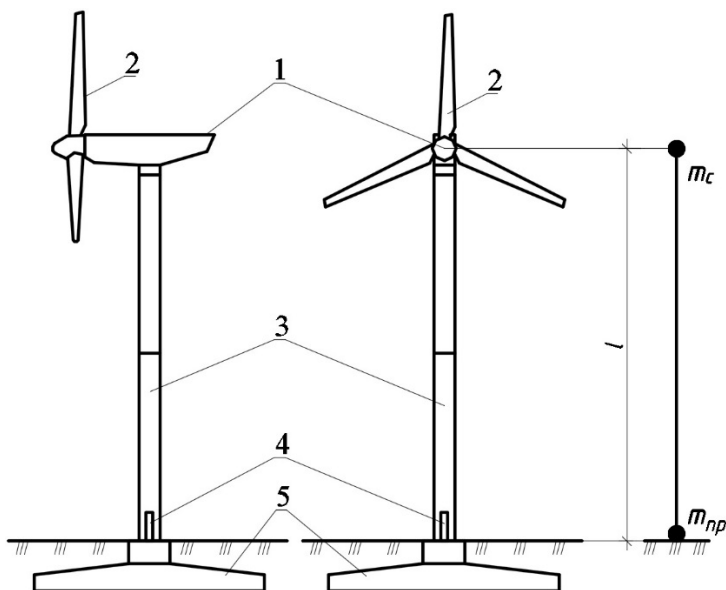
Ветроэнергетическая установка: 1 – гондола; 2 – ветроколесо; 3 – опора ветроэнергетической установки; 4 – анкерные болты; 5 – фундамент
